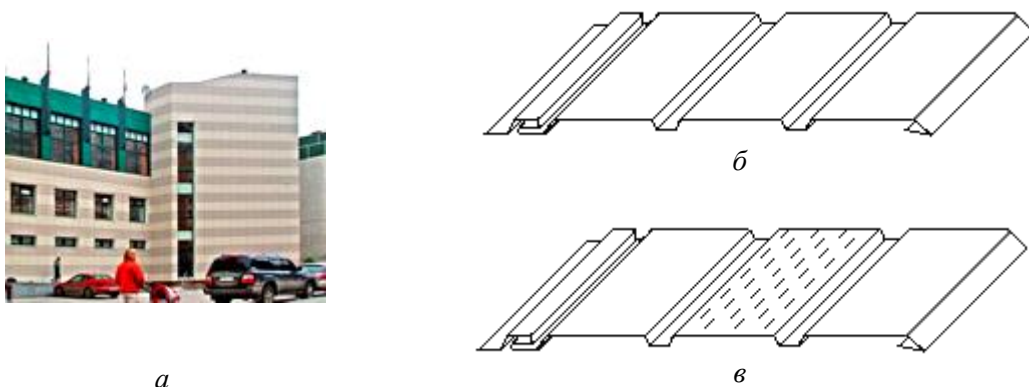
Вентилювані алюмінієві начіпні фасади:
